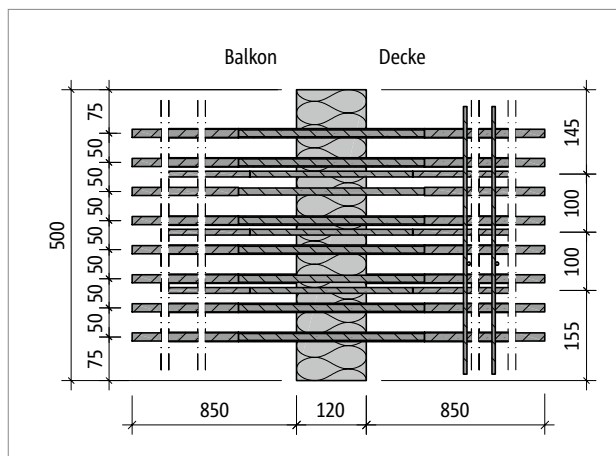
Schöck Isokorb® XT Typ KP-M13: Produktgrundriss
